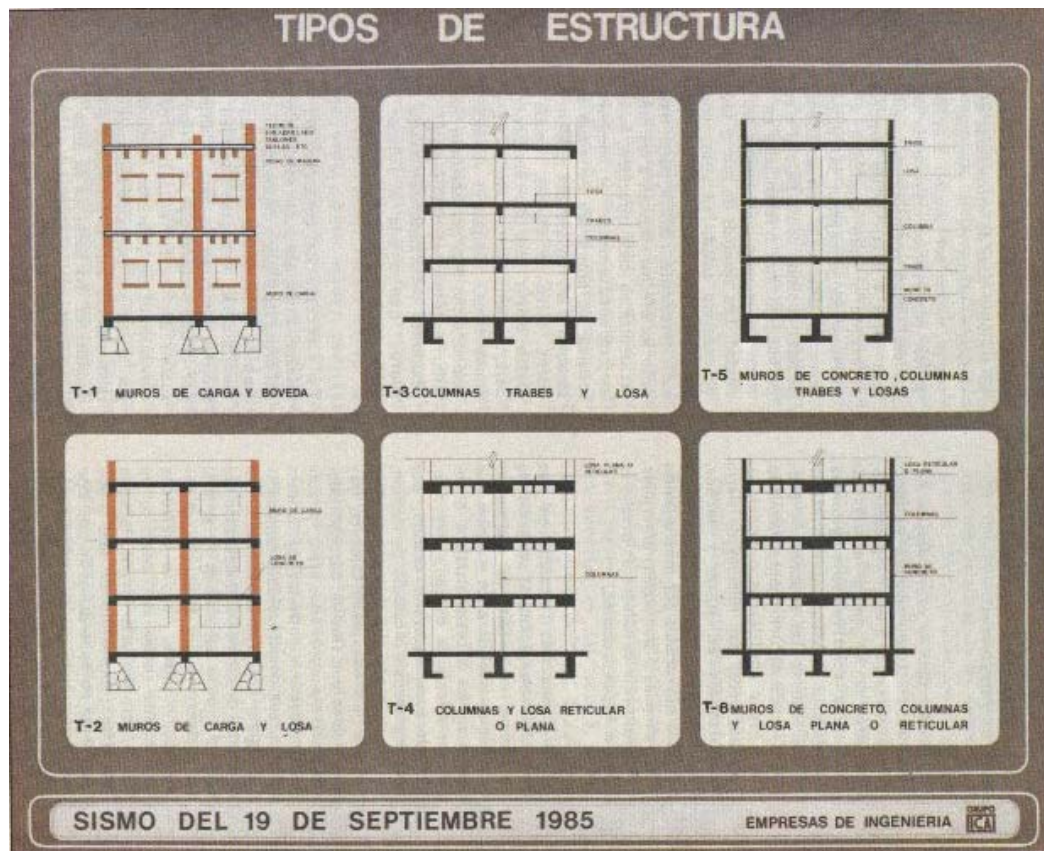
Tipos de estructuras (“Fundación ICA”, 1988)
